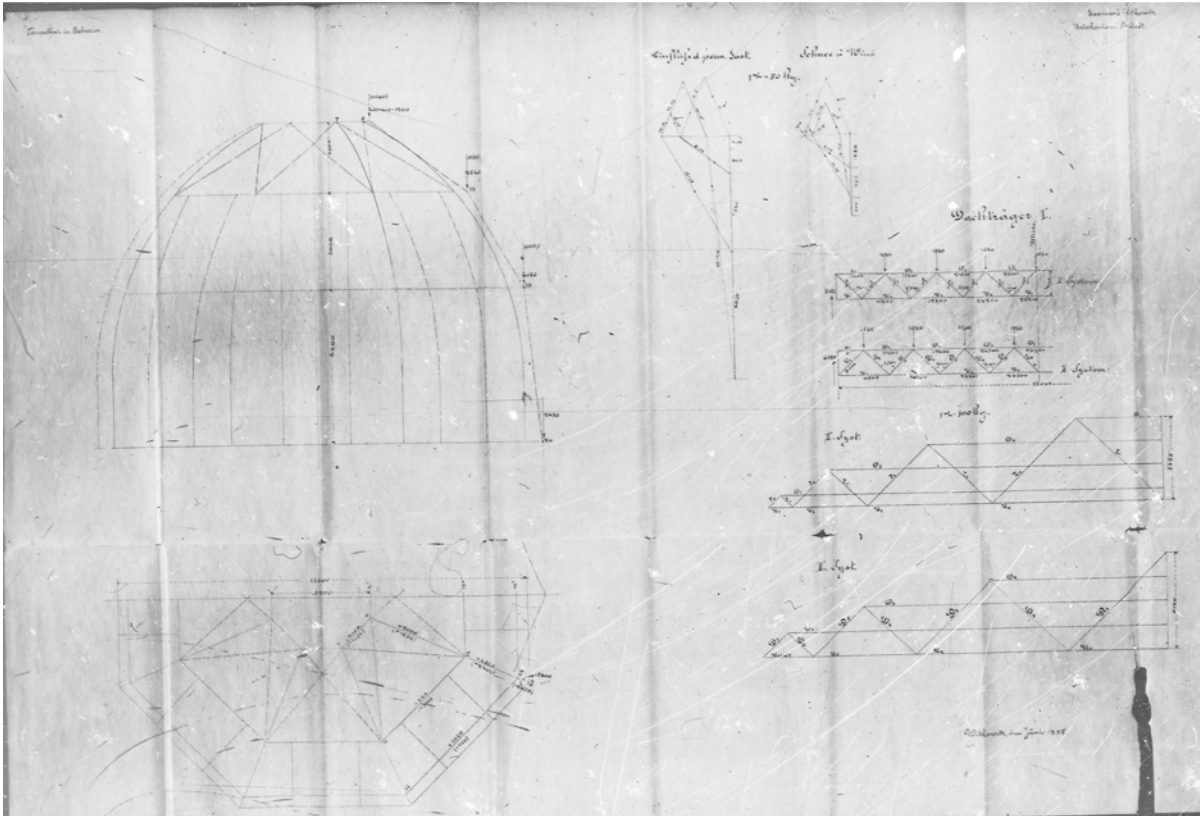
Stahlkonstruktion Kuppel Detail 04
